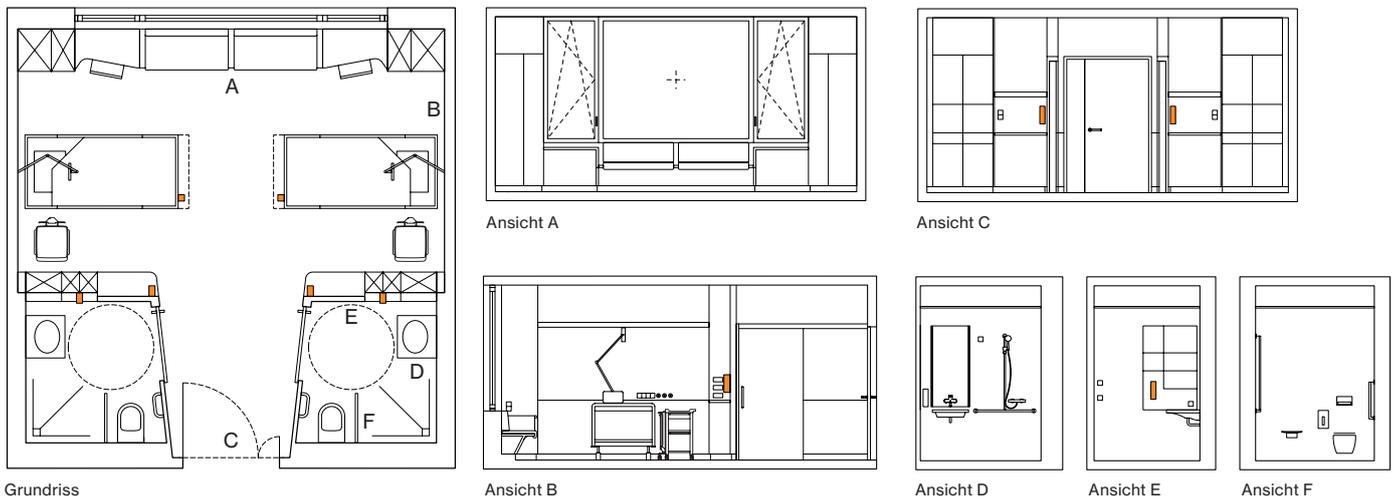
Finaler Entwurf – Grundriss und Ansichten, M 1:100
